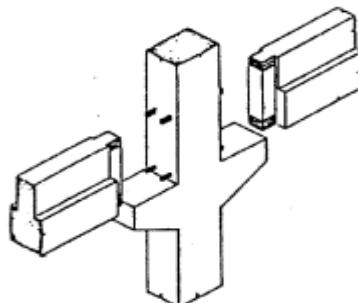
Sambungan Basah (*In-Situ Concrete Joint*)
